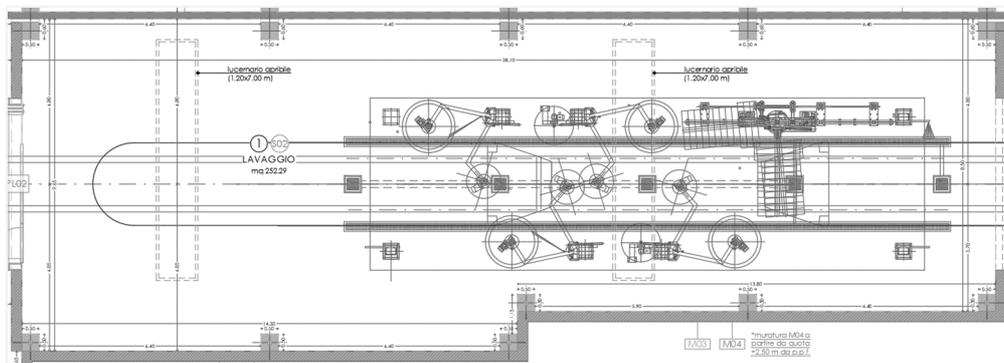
Vista planimetrica impianto di lavaggio - dettaglio
